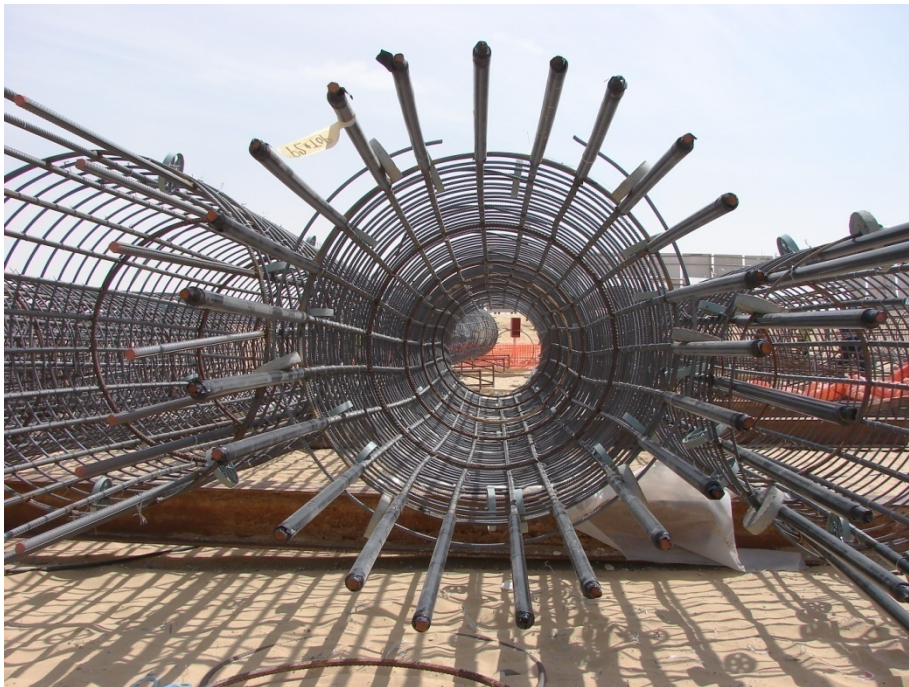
Bewehrungskorb für die Großbohrpfähle des I&M Tower (Foto: Sabrina Knecht)
